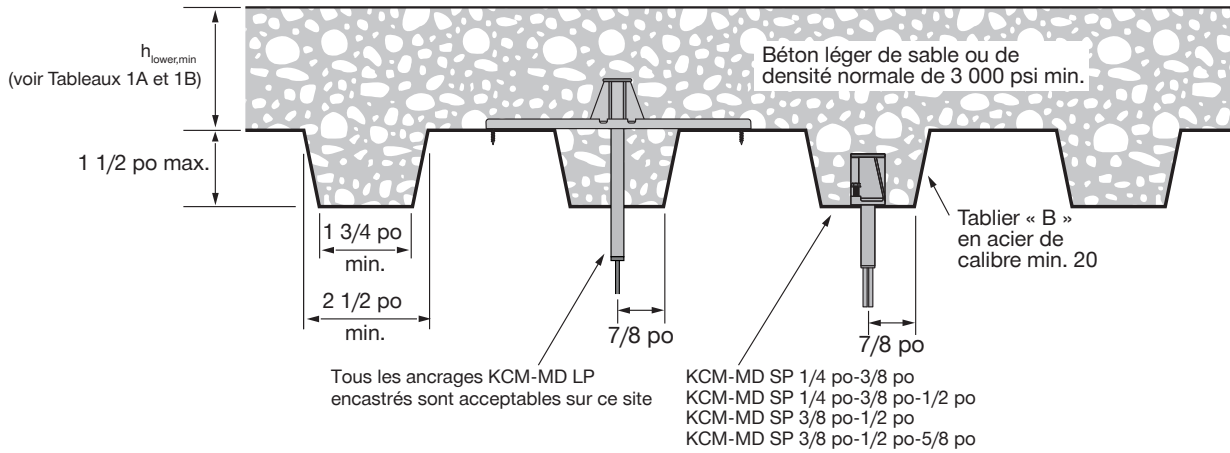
C – Installation dans le soffite d'un plancher ou d'un toit en béton sur tablier métallique sur la cannelure inférieure (tablier « B »)
